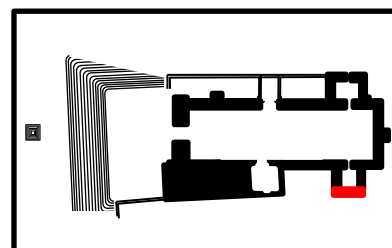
Detalle de la jamba izquierda del muro frontal
